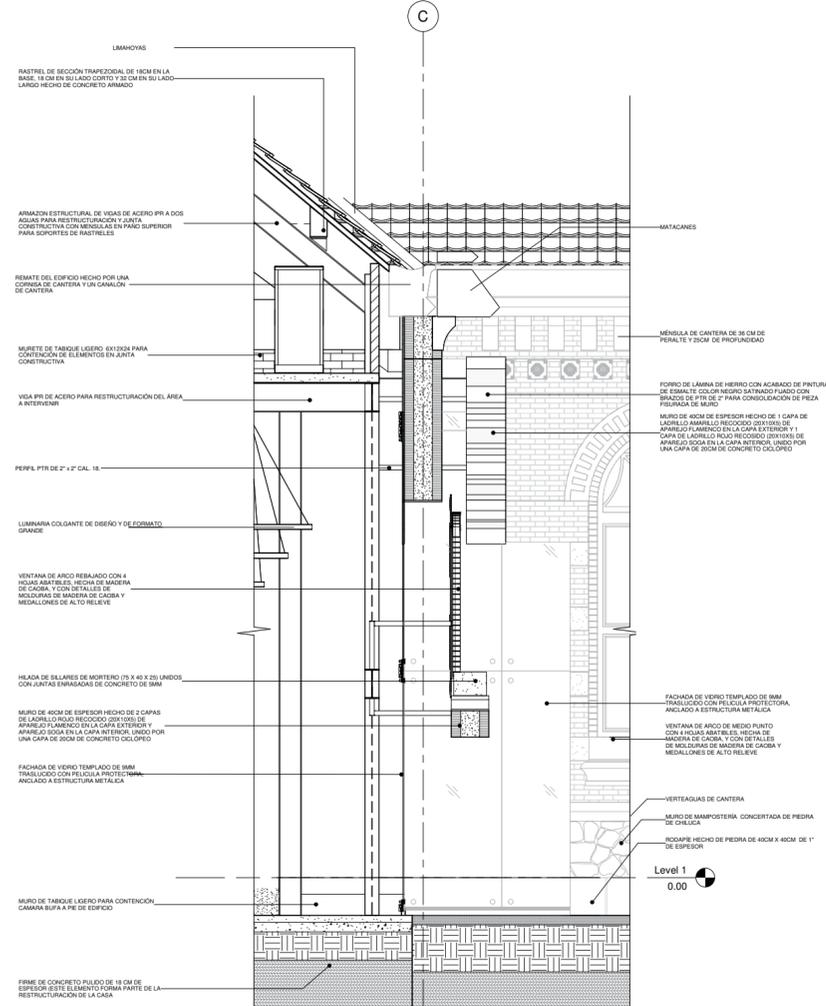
Corte por fachada - Consolidación fachada Sur.
